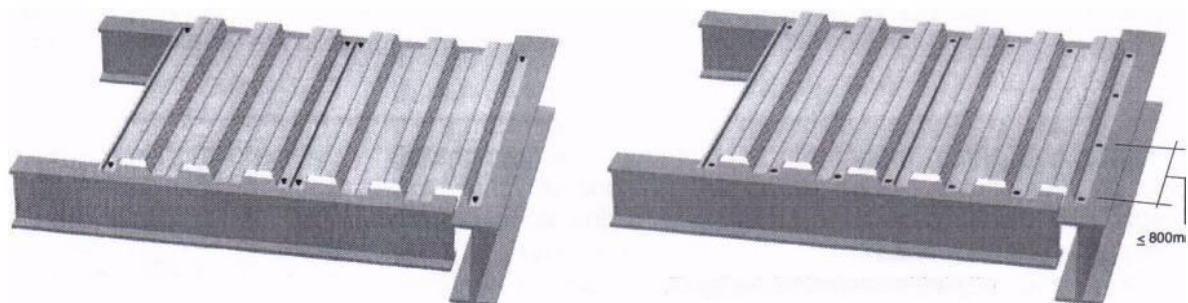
Detalhe da fixação da laje *Steel Deck* na viga
